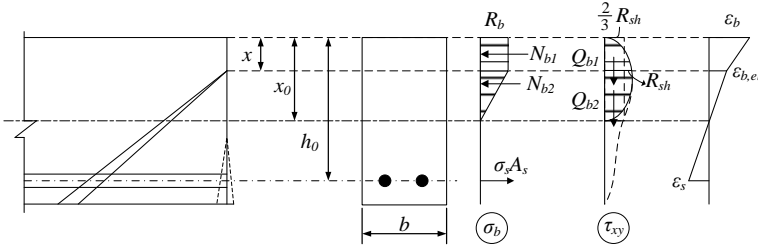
Расчетная схема изгибаемого железобетонного элемента и эпюры нормальных и касательных напряжений в бетоне
